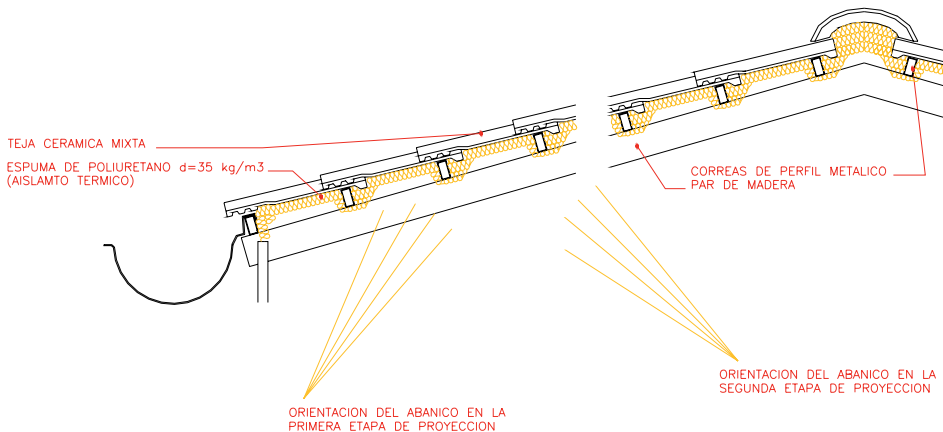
Rehabilitación de la cubierta inclinada con espuma de poliuretano bajo teja.
